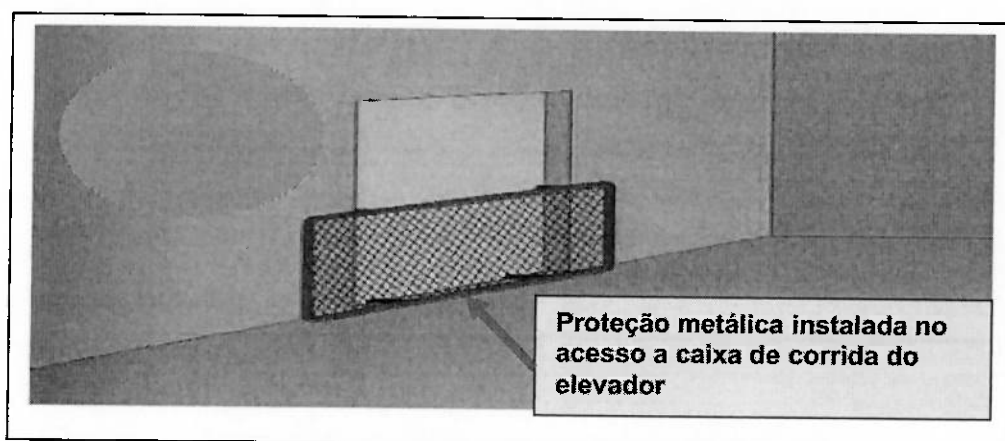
Modelo da proteção metálica de pavimento nos elevadores
